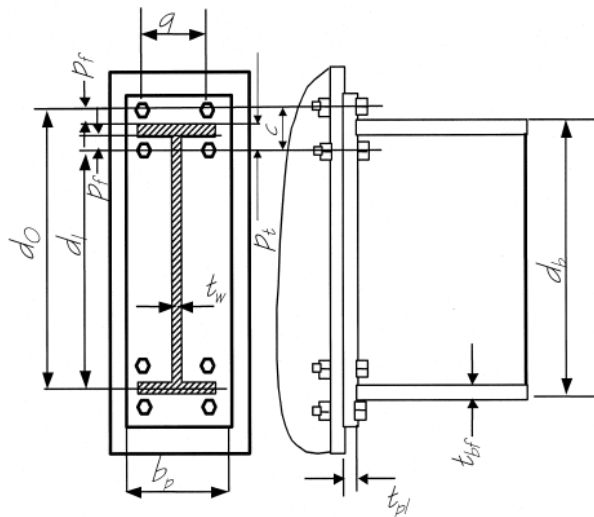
c. Assemblage par platines d'à bout non raidies soudées à la poutre et boulonnées à l'aile du poteau par 4 rangées de boulons.
